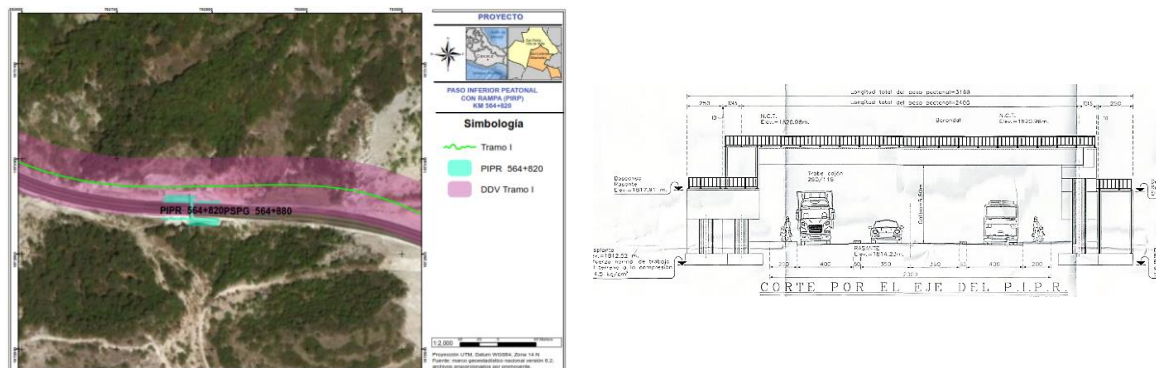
Proyecto en planta y corte transversal del PIPR 564+820
